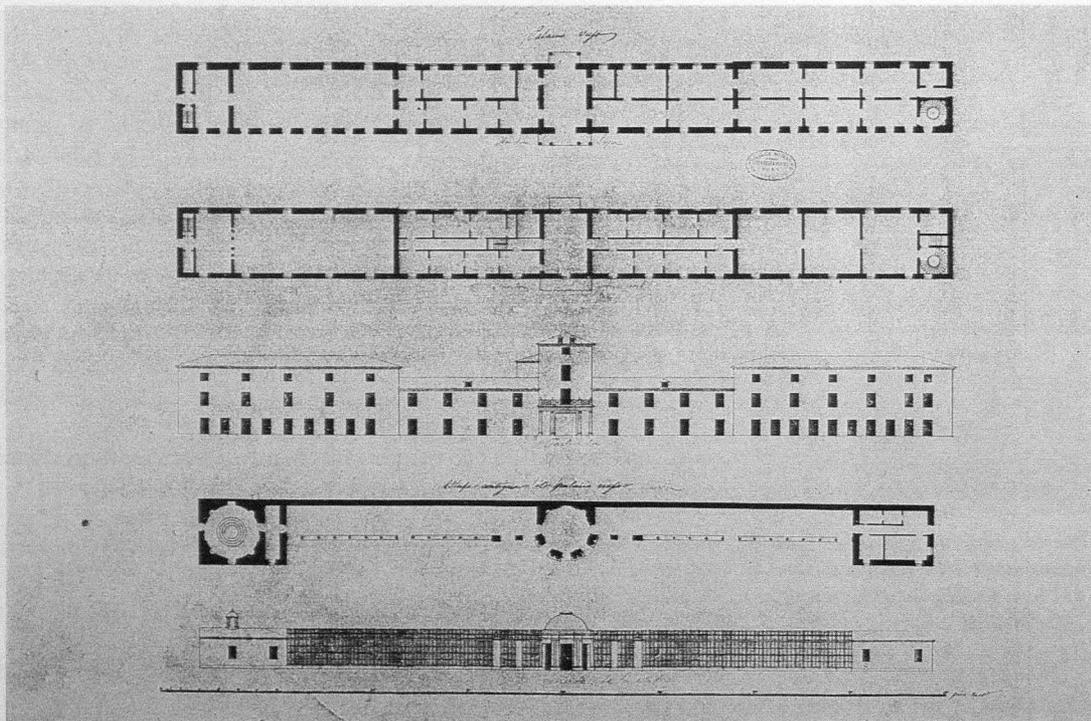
Planta baja, principal y alzado del Palacio Viejo, y planta y alzado de la estufa (tinta china y color a la aguada sobre cartulina, 569 por 839 mm. Escala: gráfica en pies castellanos). Sección planos, n° 3.517, A.G.P., Madrid.
